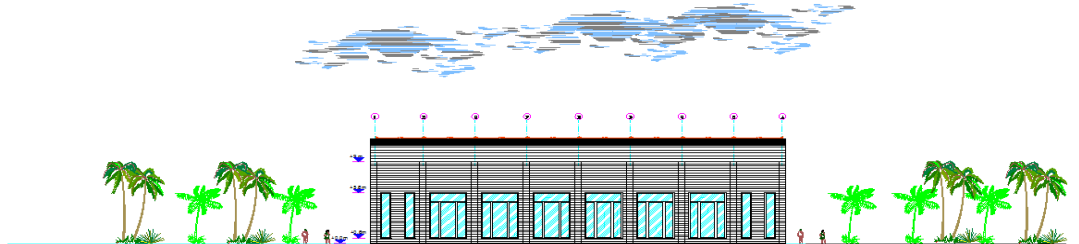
الواجهة الغربية للقاعة الرياضية .
